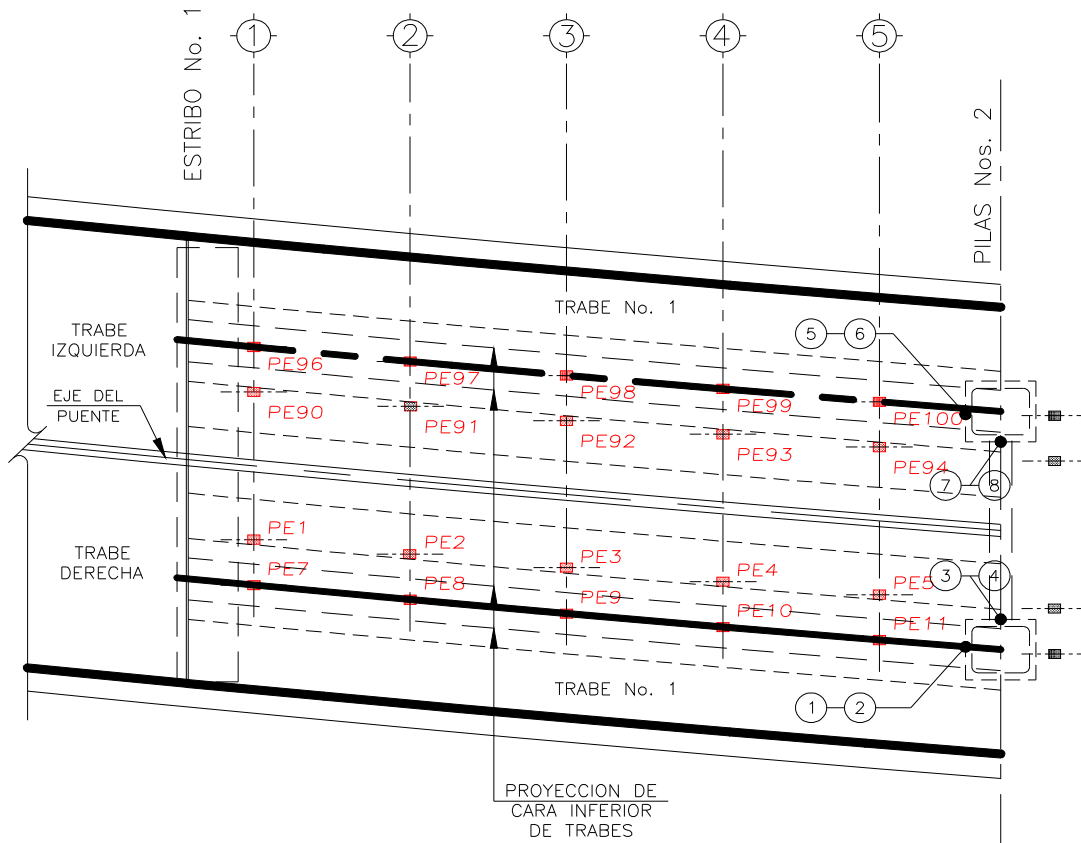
Ubicación en planta de Pruebas con esclerómetro.
